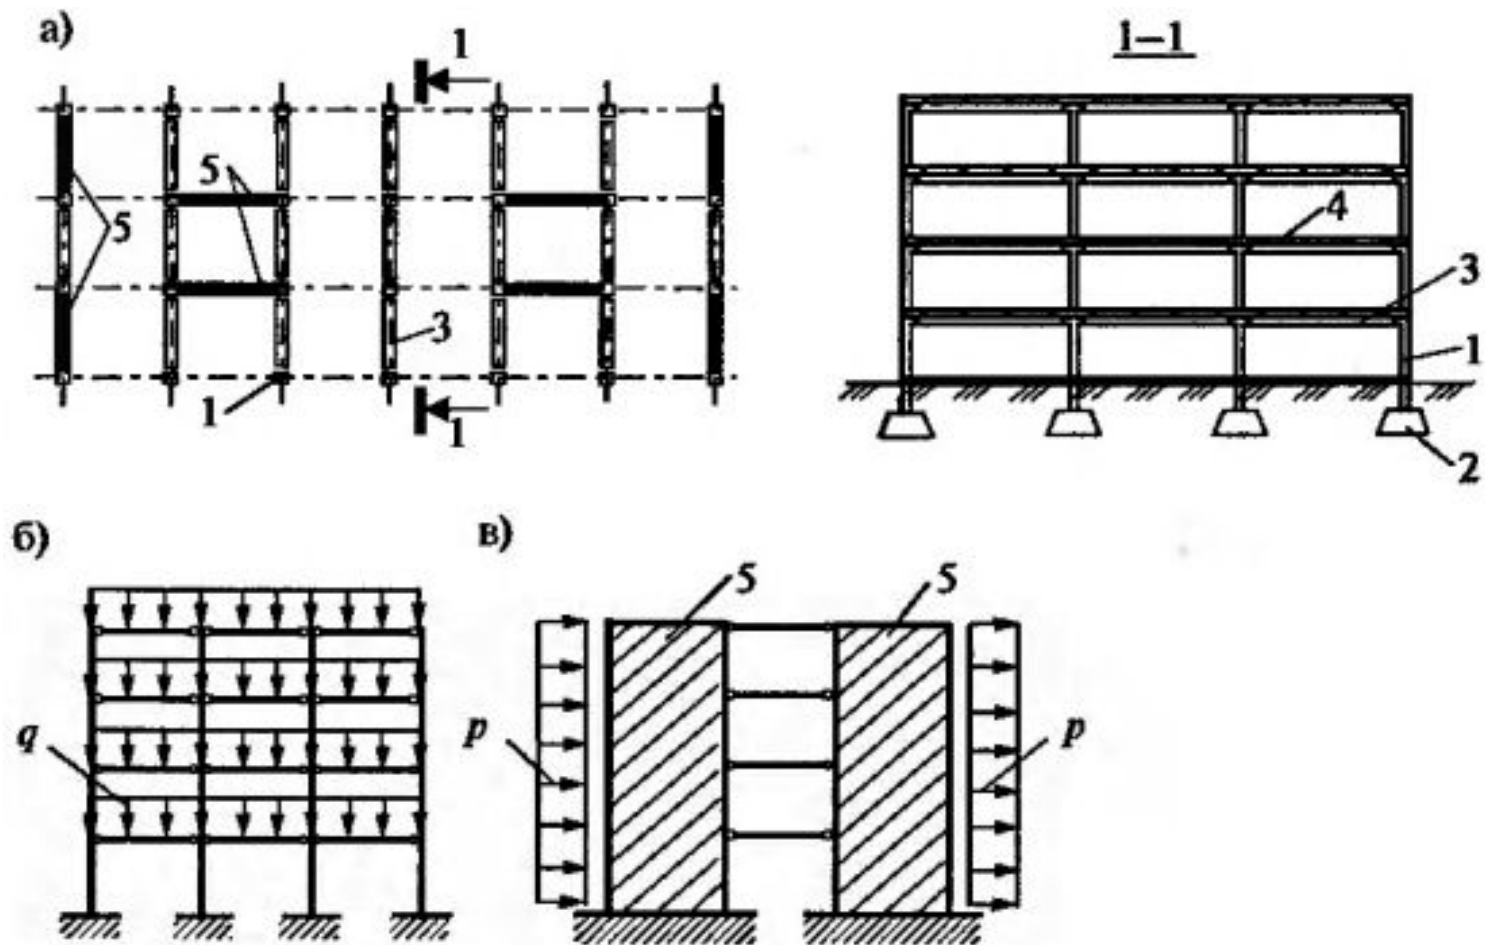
Связевой каркас здания: а) план здания, разрез; б) расчетная схема при расчете на вертикальную нагрузку; в) расчетная схема при расчете на горизонтальную нагрузку; 1 — колонна; 2 — фундамент; 3 — разрезной (однопролетный) ригель; 4 — плиты перекрытия; 5 — диафрагмы жесткости
